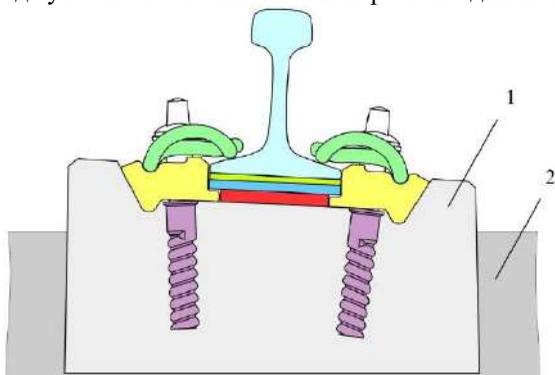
Промежуточное крепление Vossloh 300 UTS на железобетонном блоке БО:
